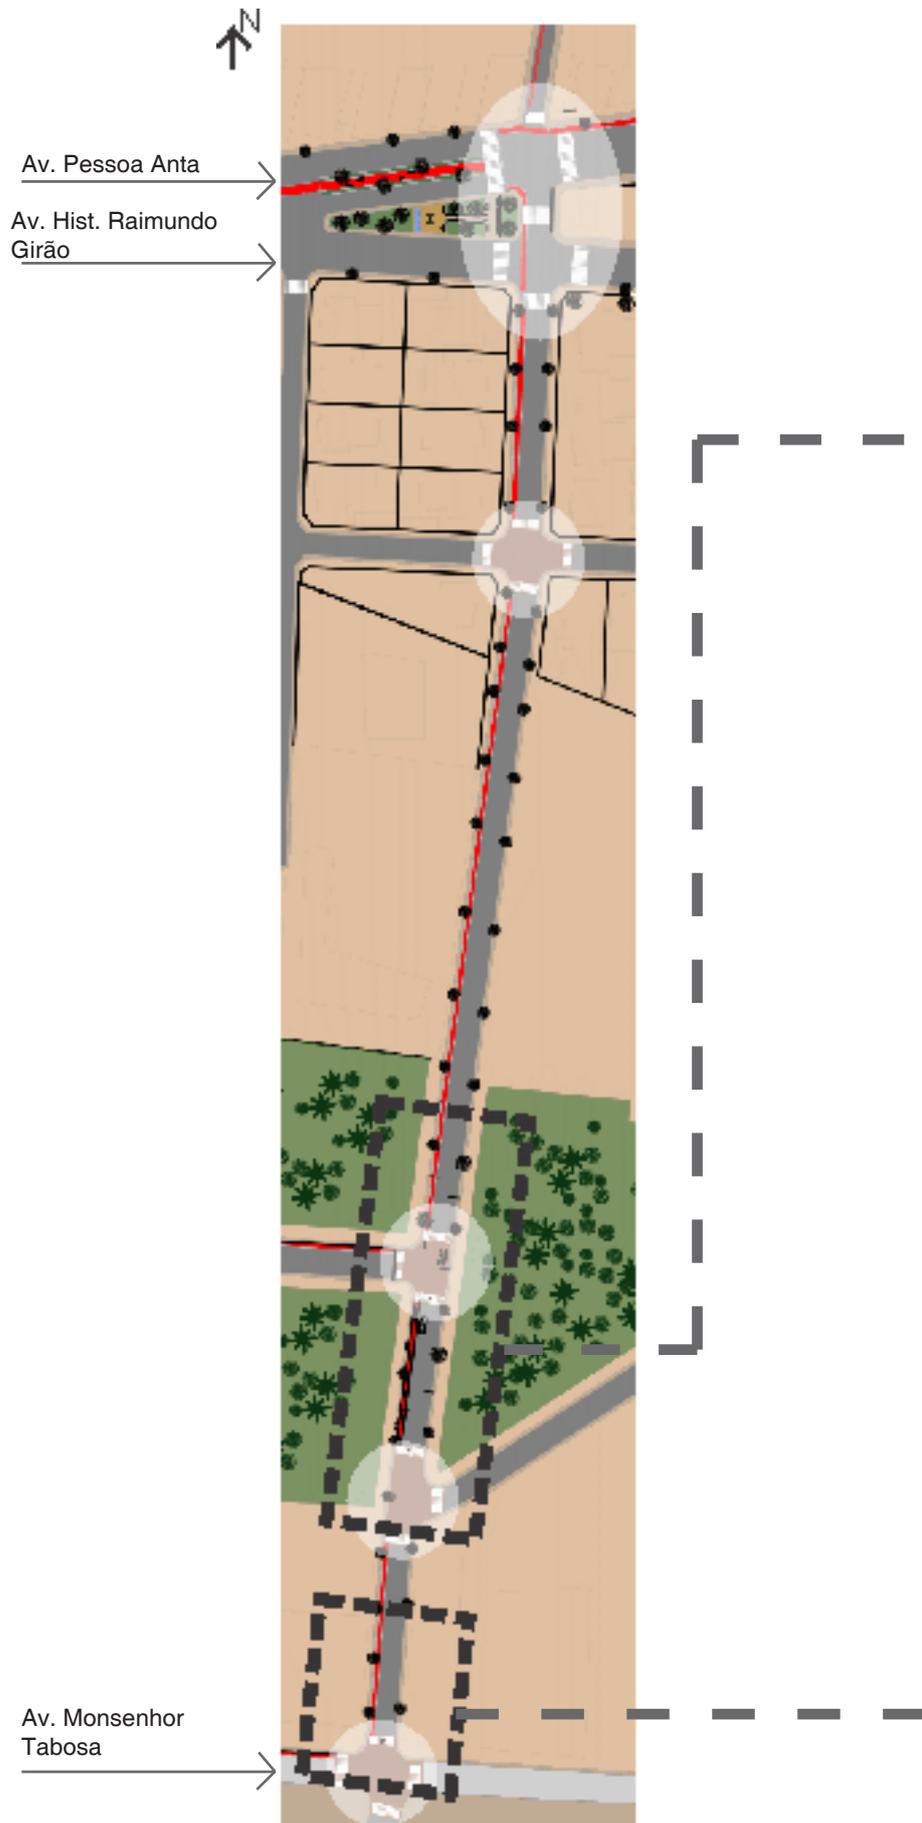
Planta baixa proposta para Rua Guarino Alves.
